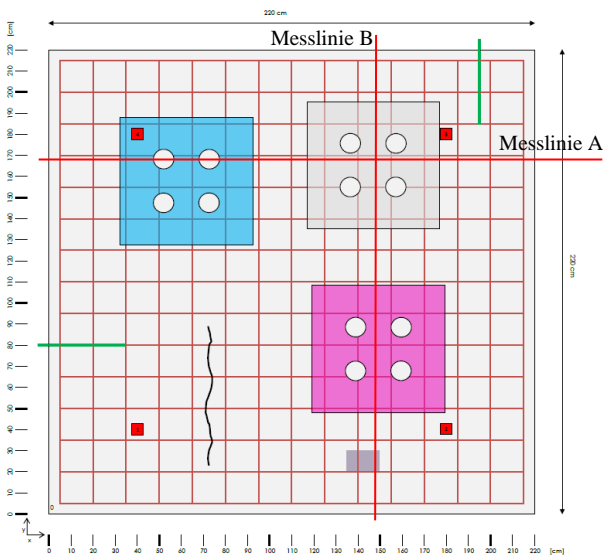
Planskizze Prüfkörper (Bauteildicke 200 mm) mit Messlinie A. Bei der grau eingefärbten Einlage handelt es sich um eine während des Betoniervorgangs eingelegte PE-Folie.
